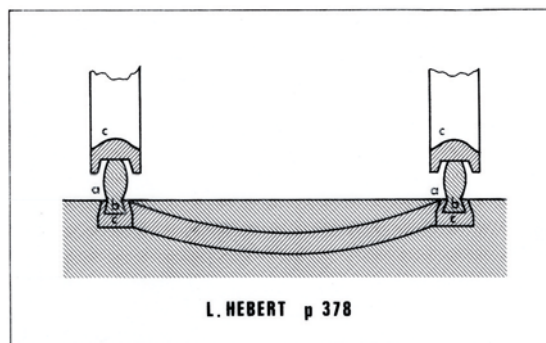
Modificación introducida en la sección del carril oval y en las llantas de las ruedas para evitar desgastes, según Herbert (1849). (Archivo RENFE).
